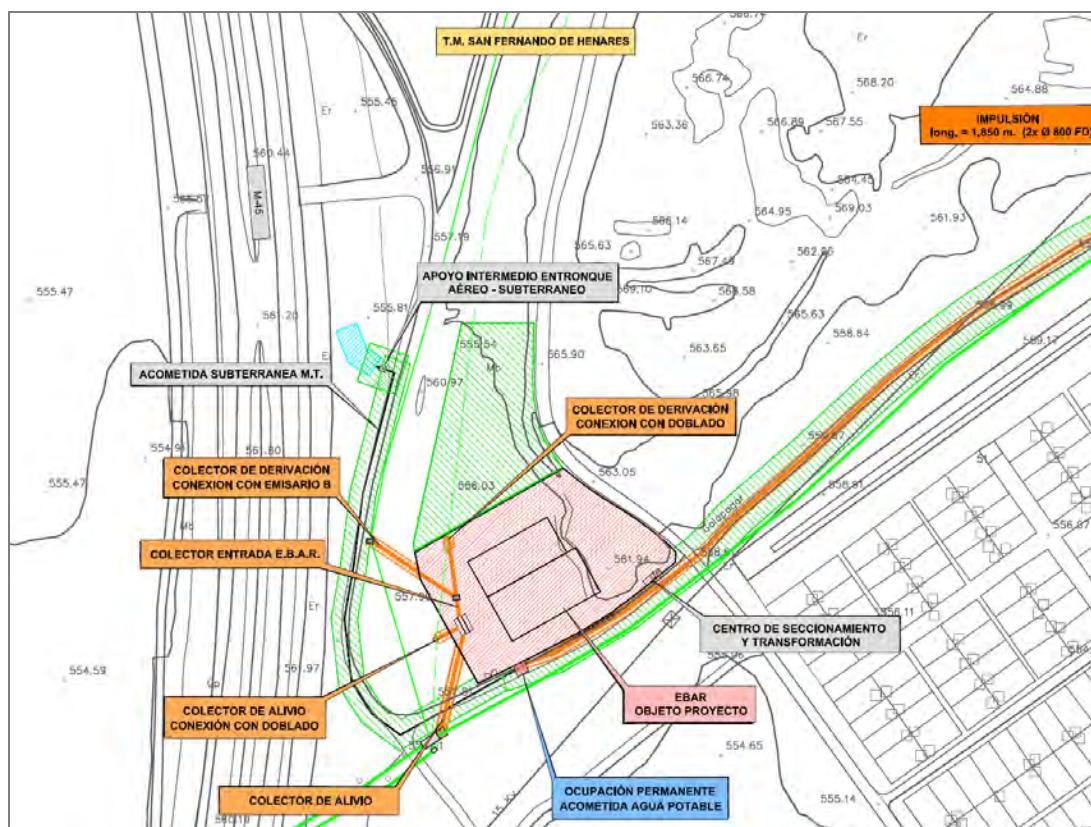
Alternativas de ubicación EBAR 3A
